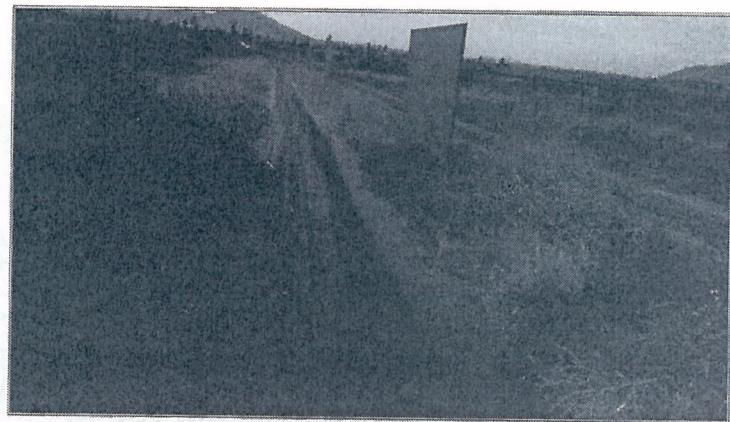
Estado actual Canal perimetral norte de poniente a oriente.
